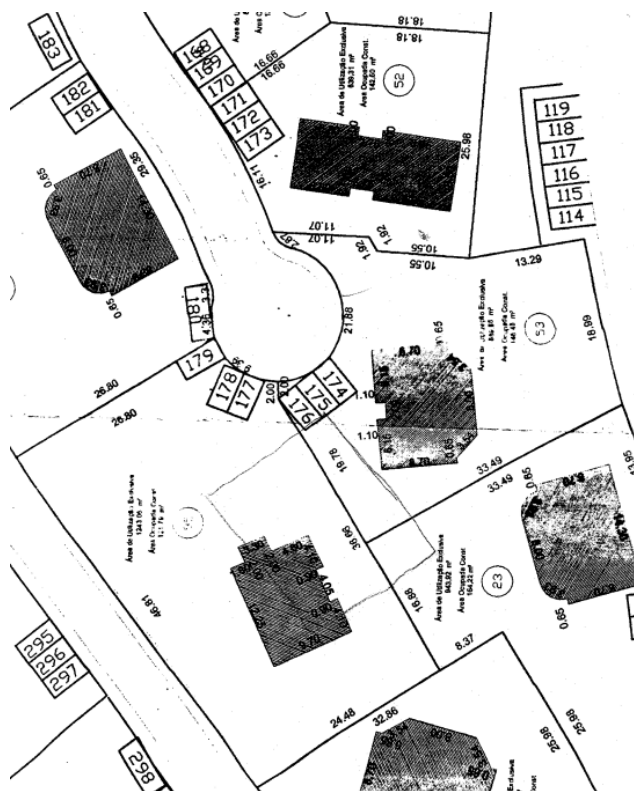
Planta do Terreno fornecida pela parte Autora aos Reus (fls 290)
